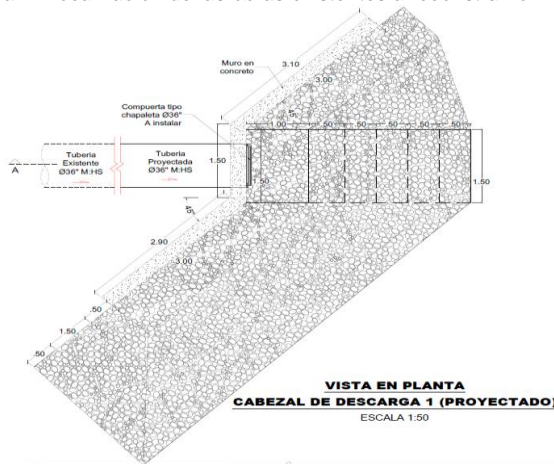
Detalle de las obras del cabezal de descarga No 1, vista en planta.
